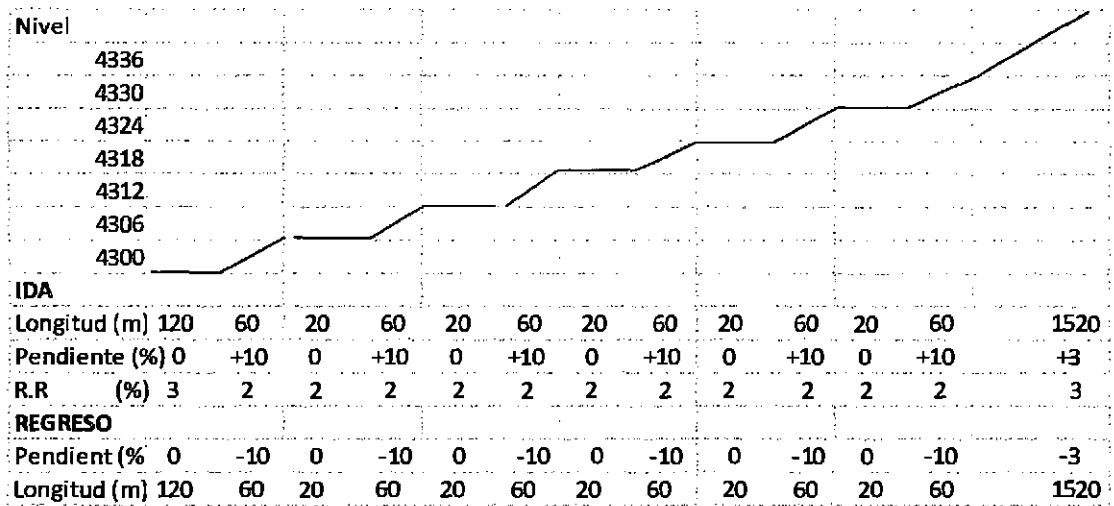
Alzado del perfil de transporte ruta N° 02
